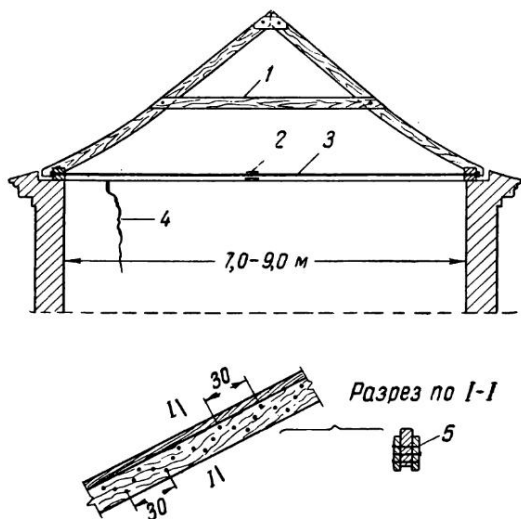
Крепление конструкции здания от распора стропил с повышенным ригелем:
